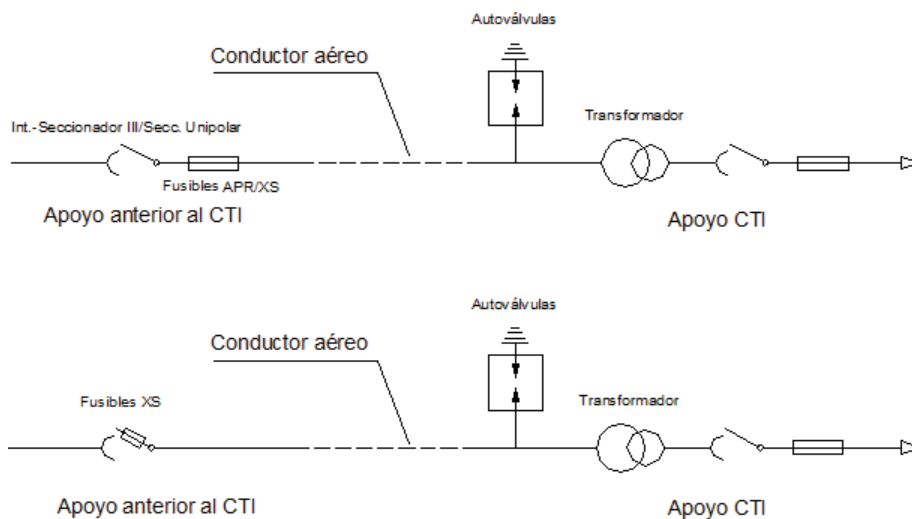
Esquema Unifilar CTI (Aparamiento y protección en apoyo anterior):
